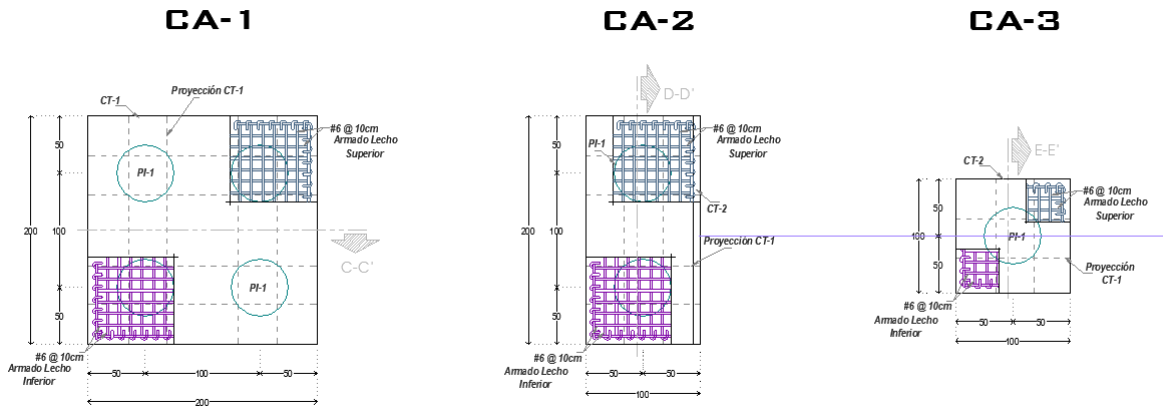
Arreglo de pilas y dados de cimentación para casa de máquinas (Vista en planta)
